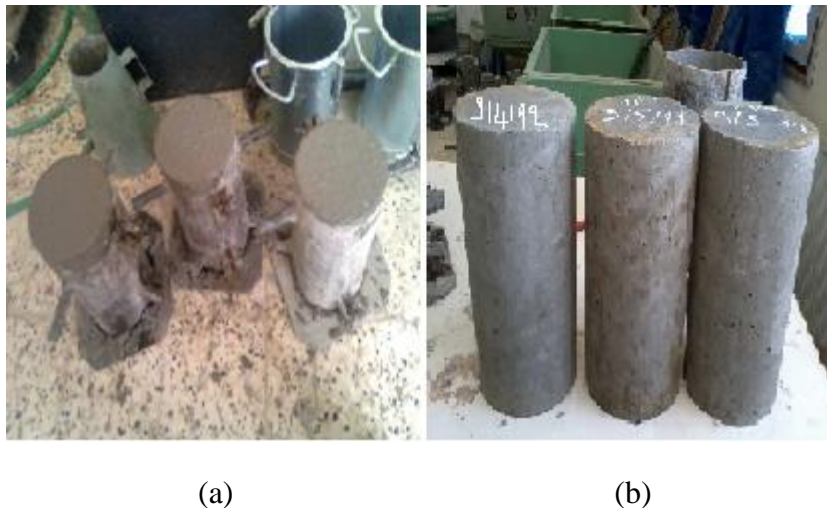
Remplissage des moules(a), Eprouvettes après décoffrage(b).
